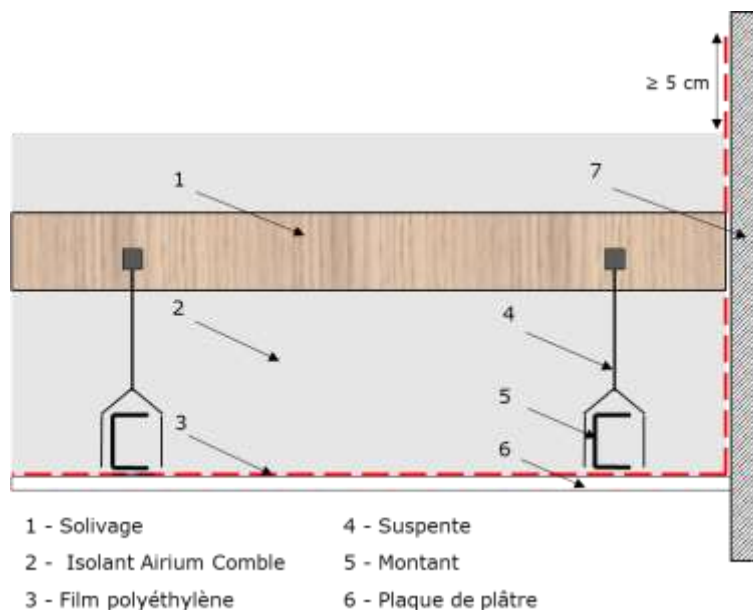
Film polyéthylène sur plafond suspendu avec montant en plaque de plâtre
